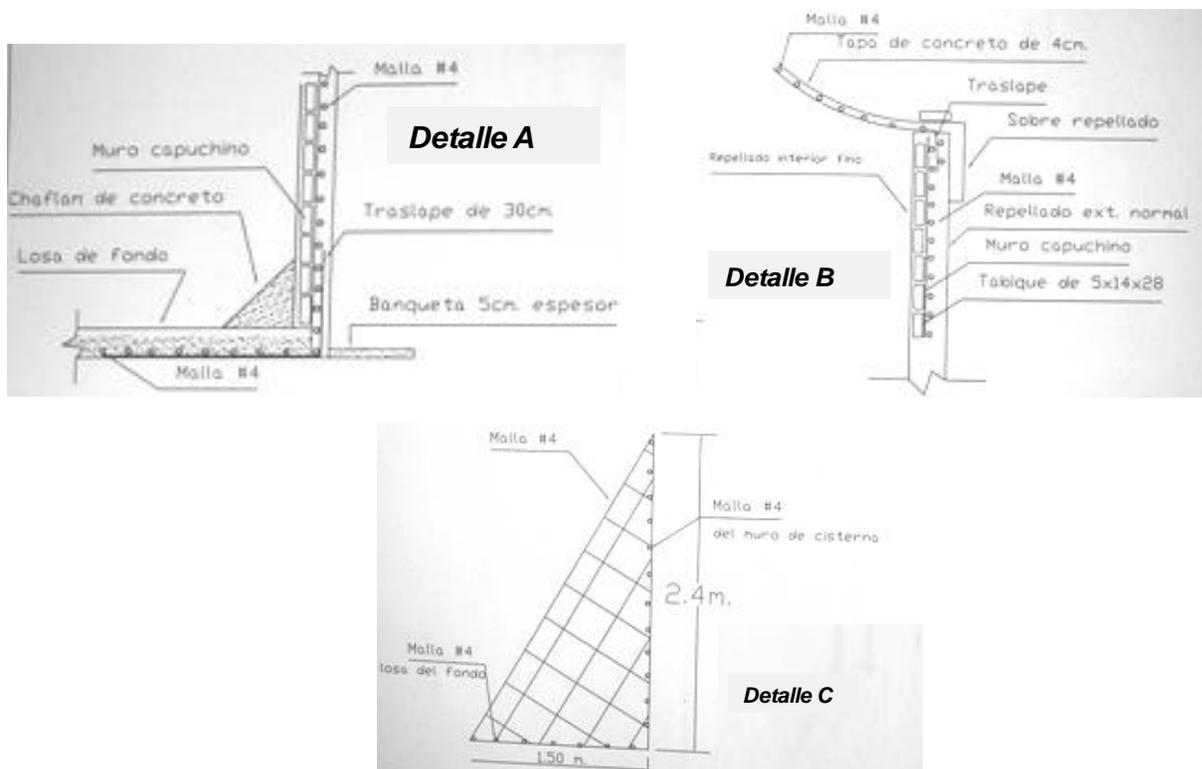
Detalles constructivos de la cisterna de 500 m³.
